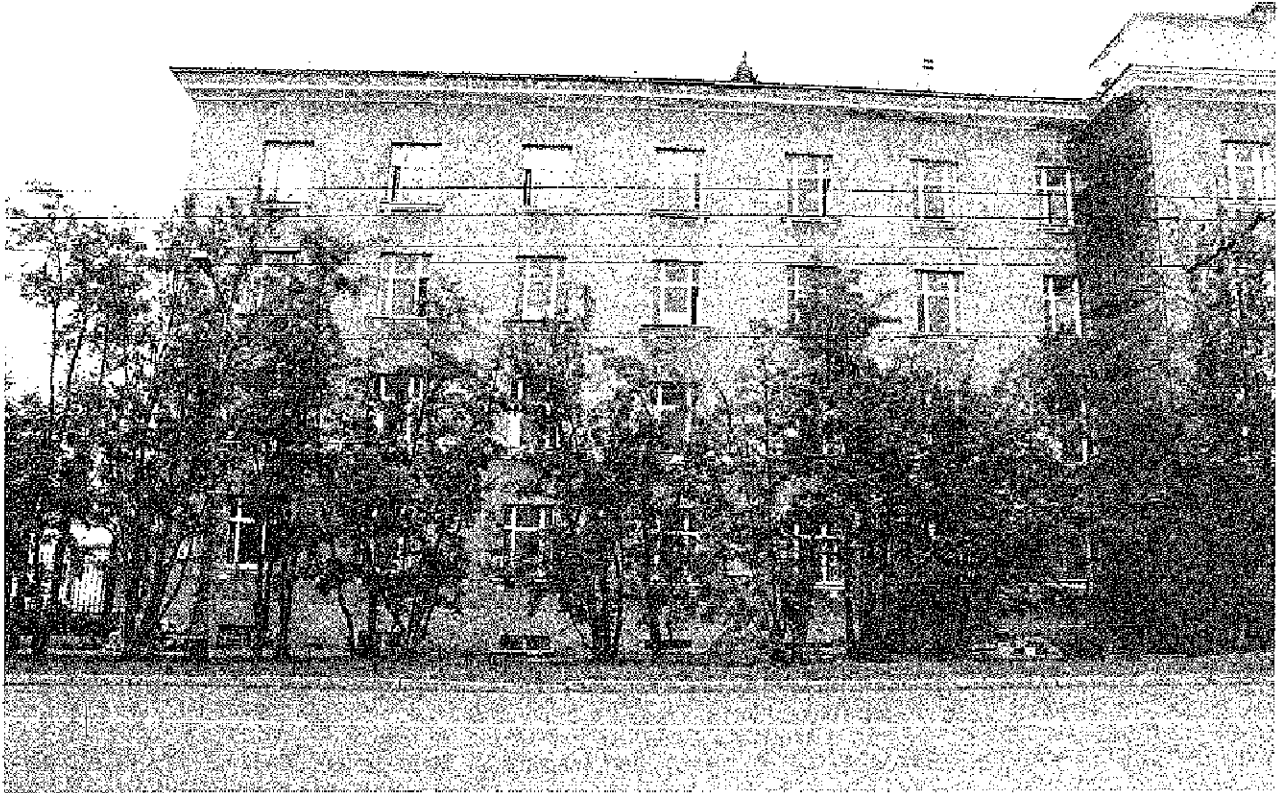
Западная часть южного фасада здания. Дата: 14.07.2021
